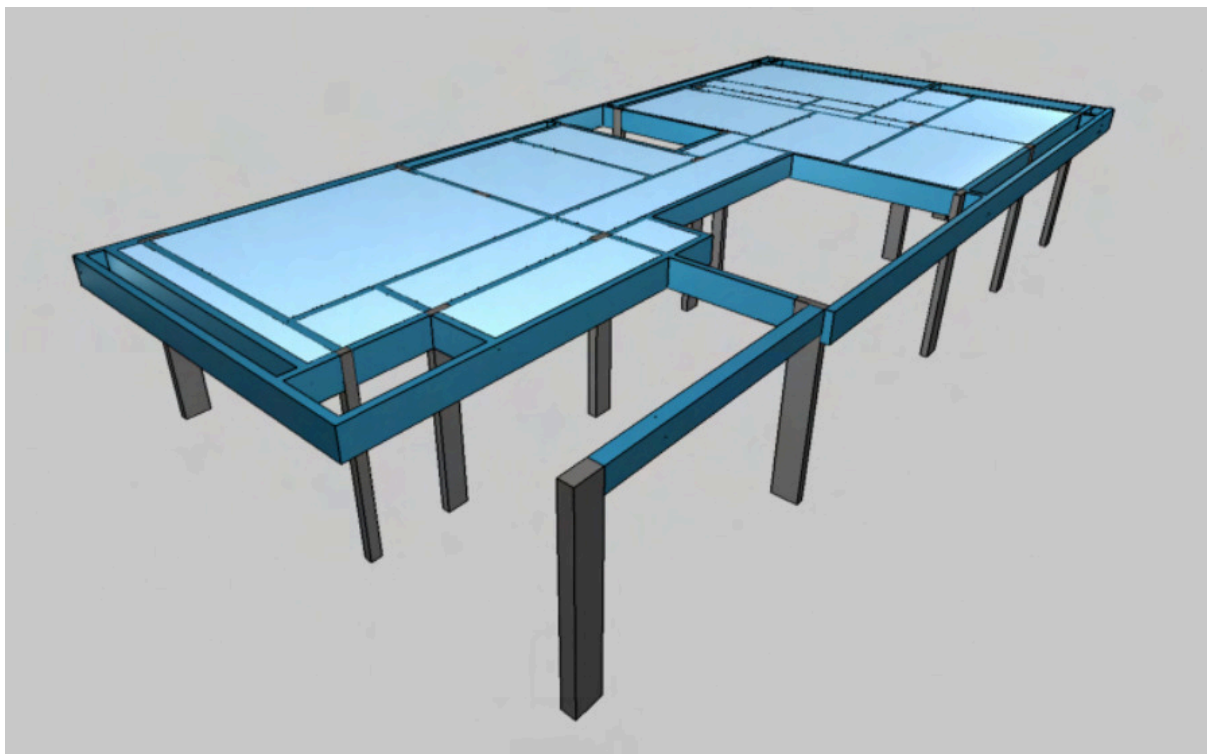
Vista 3D do lançamento estrutural - Modelo 1
